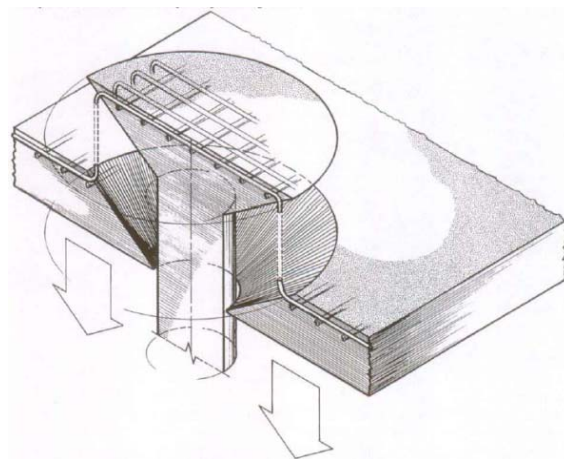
Esquema da rotura ao punçoamento de uma laje de betão armado [24]
